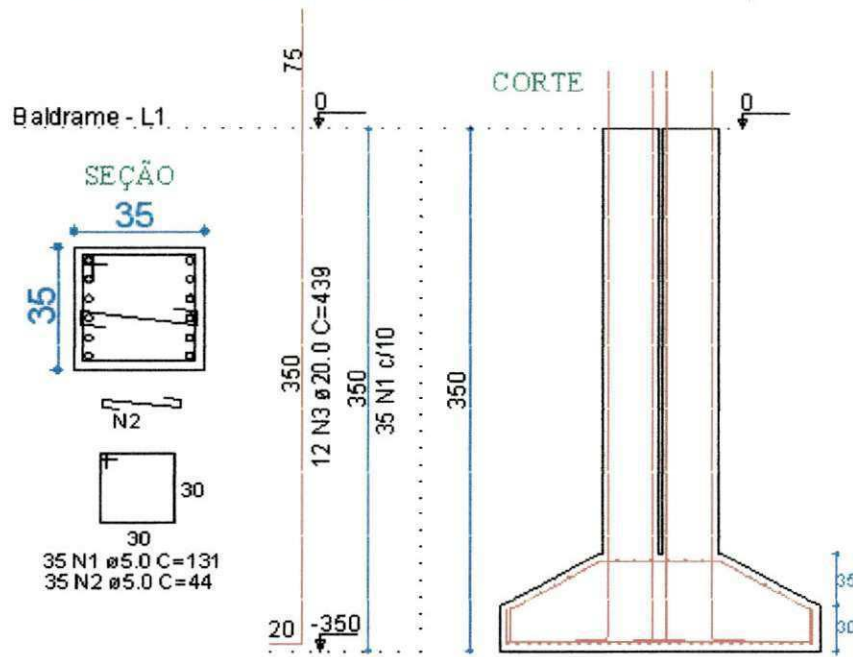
Detalhe do arranque dos pilares P59-P60.
